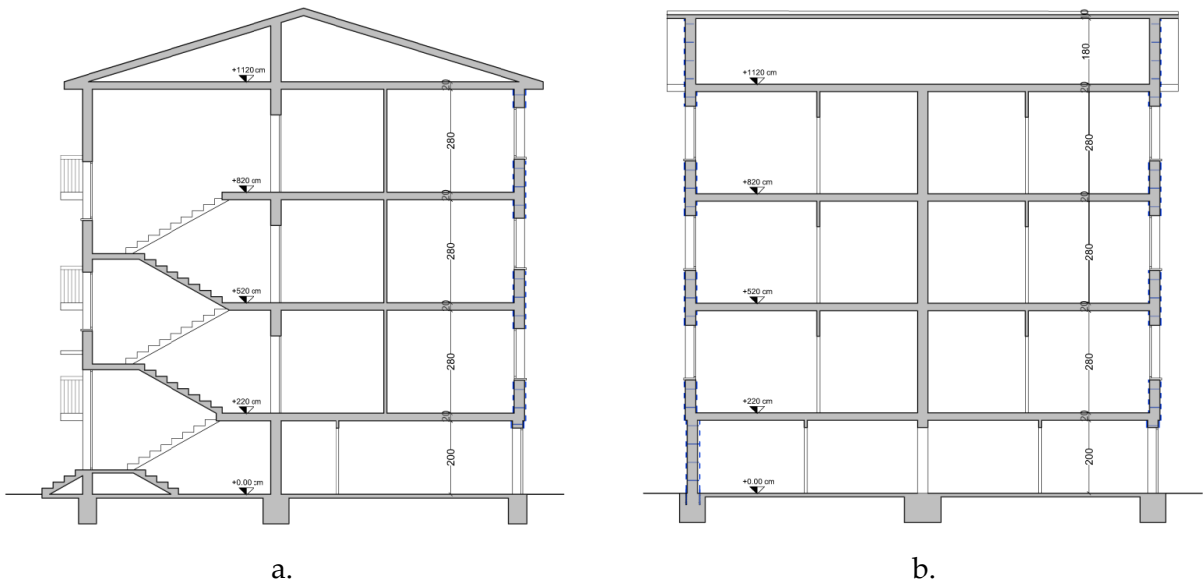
Intonaco armato con rete elettrosaldata su due lati: a) sezione A-A; b) sezione B-B
